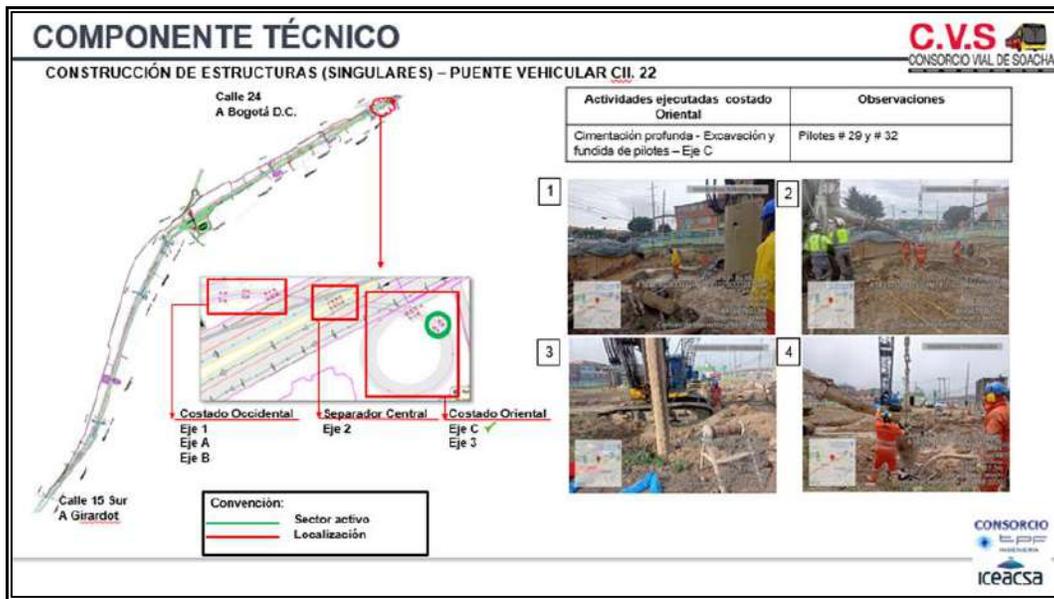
Resumen Construcción Puente Vehicular Calle 22
